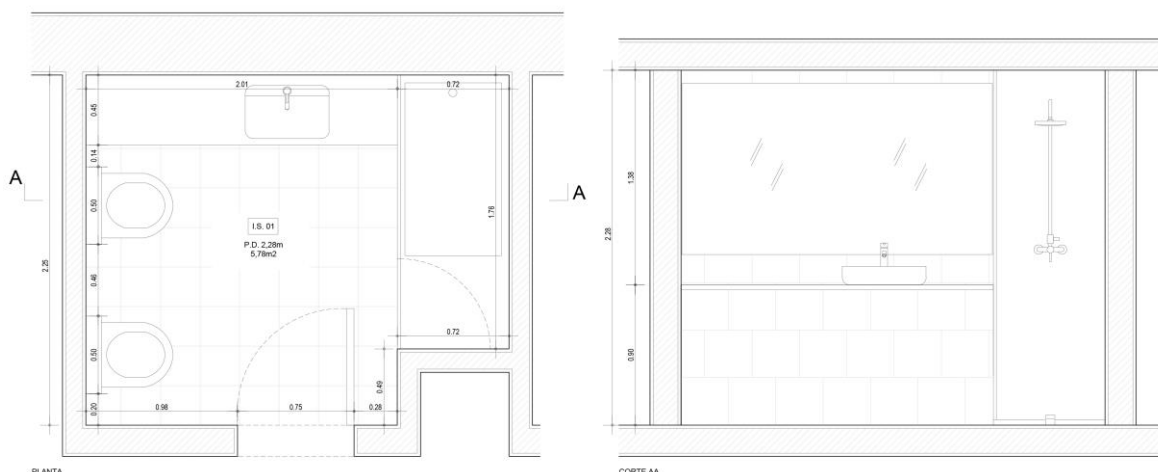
Desenhos do levantamento da instalação sanitária 01. Projecto 5.
